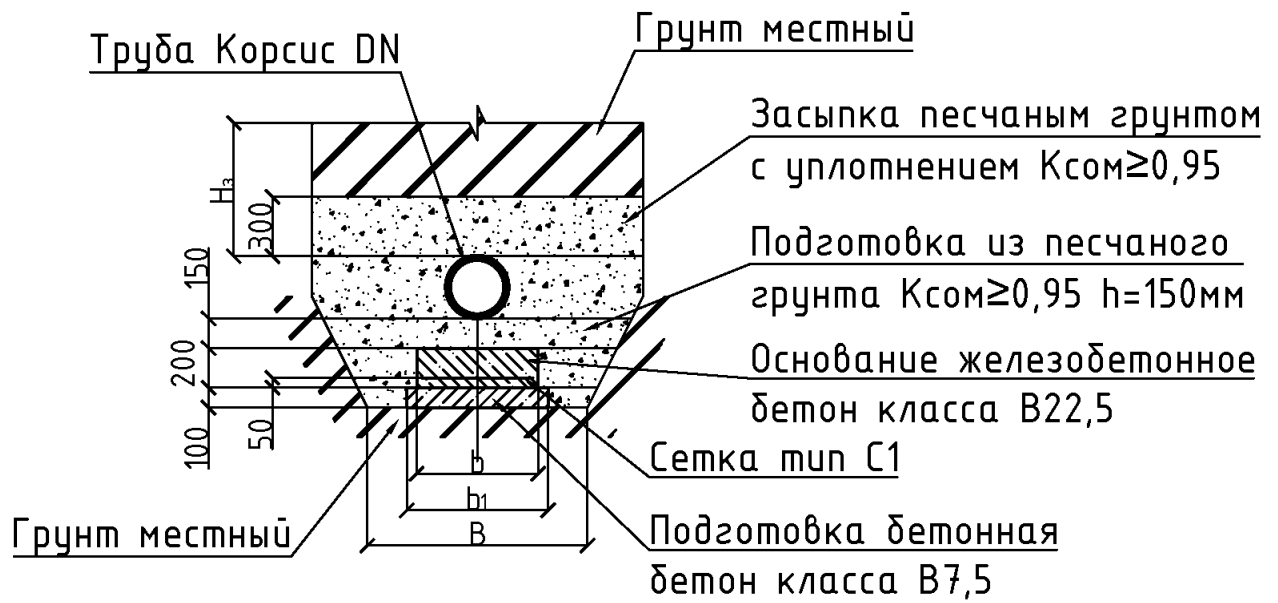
Схема, разрез и габаритные характеристики бетонного основания для подводящего трубопровода.
